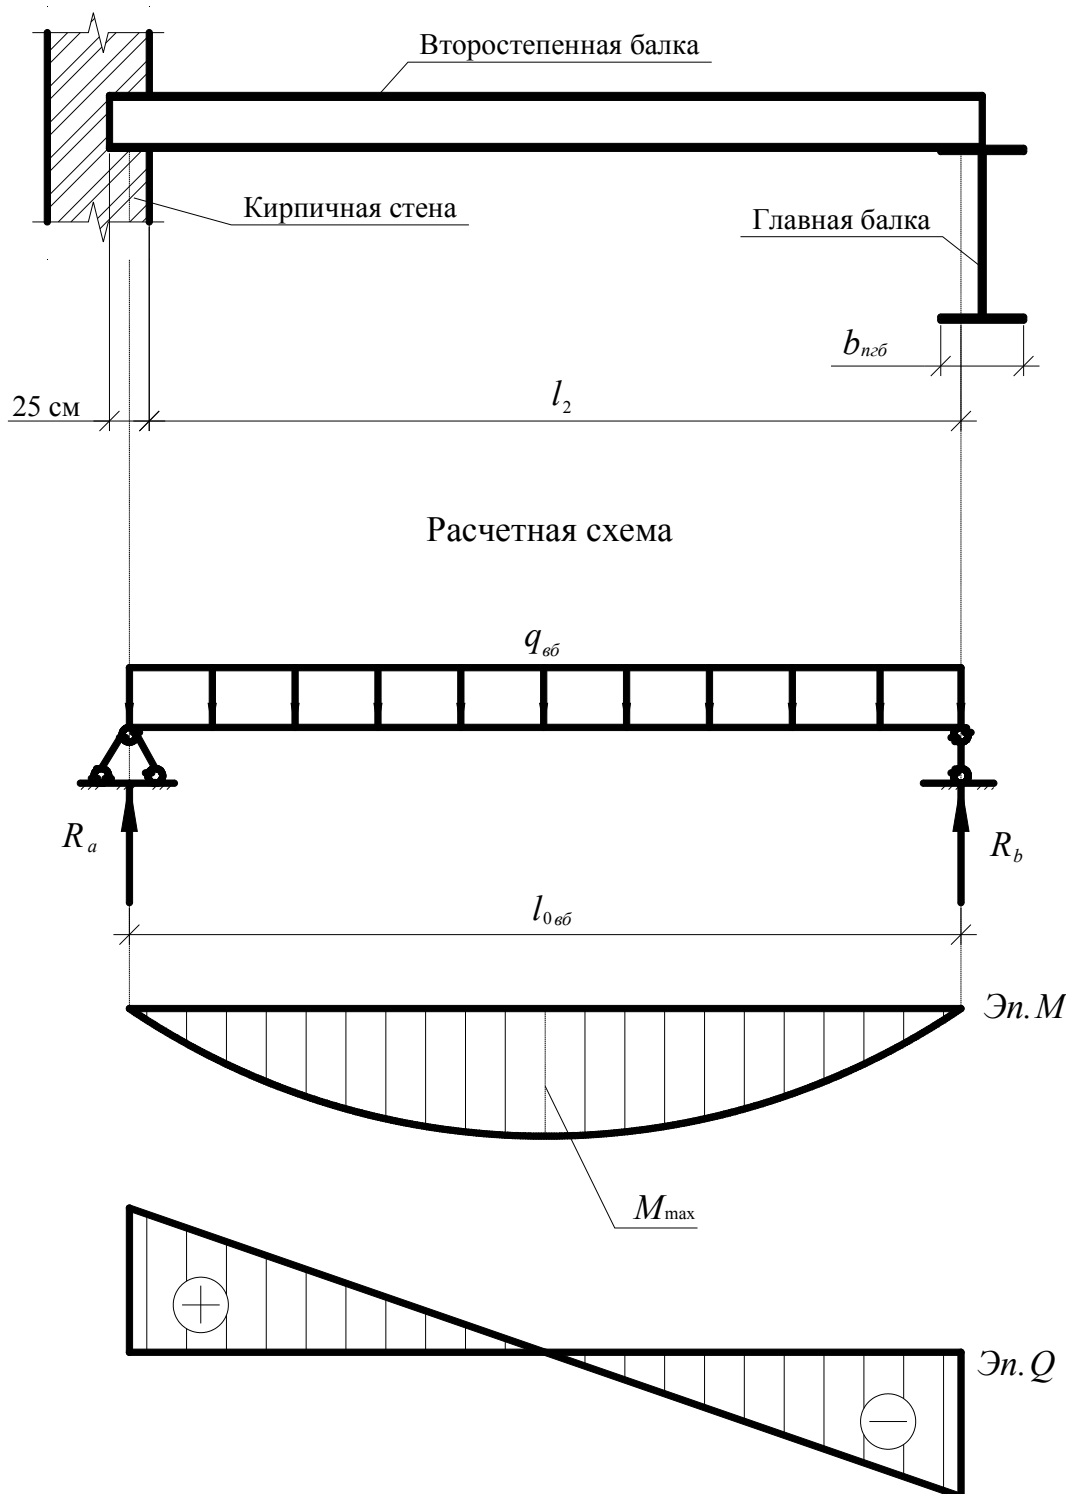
Конструктивная и расчетная схемы второстепенной балки
